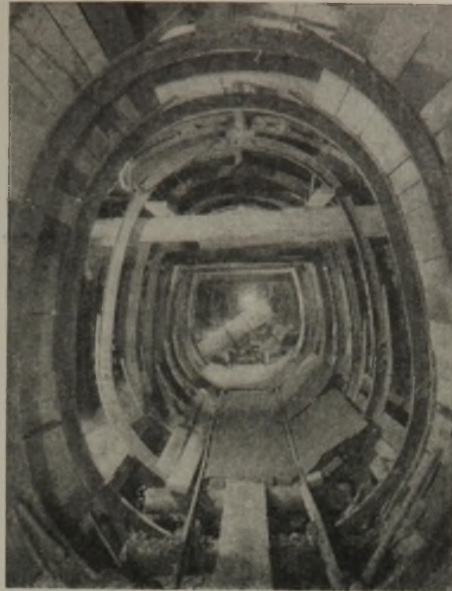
Kanal Eisenheimer Straße: Schalung für den Beton der Seitenwände und des Deckgewölbes.
